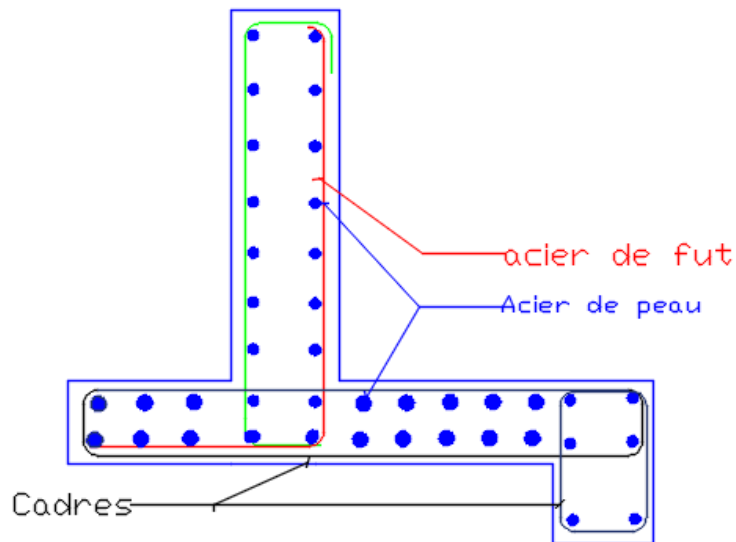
SEMELLE DU MUR DE SOUTÈNEMENT
